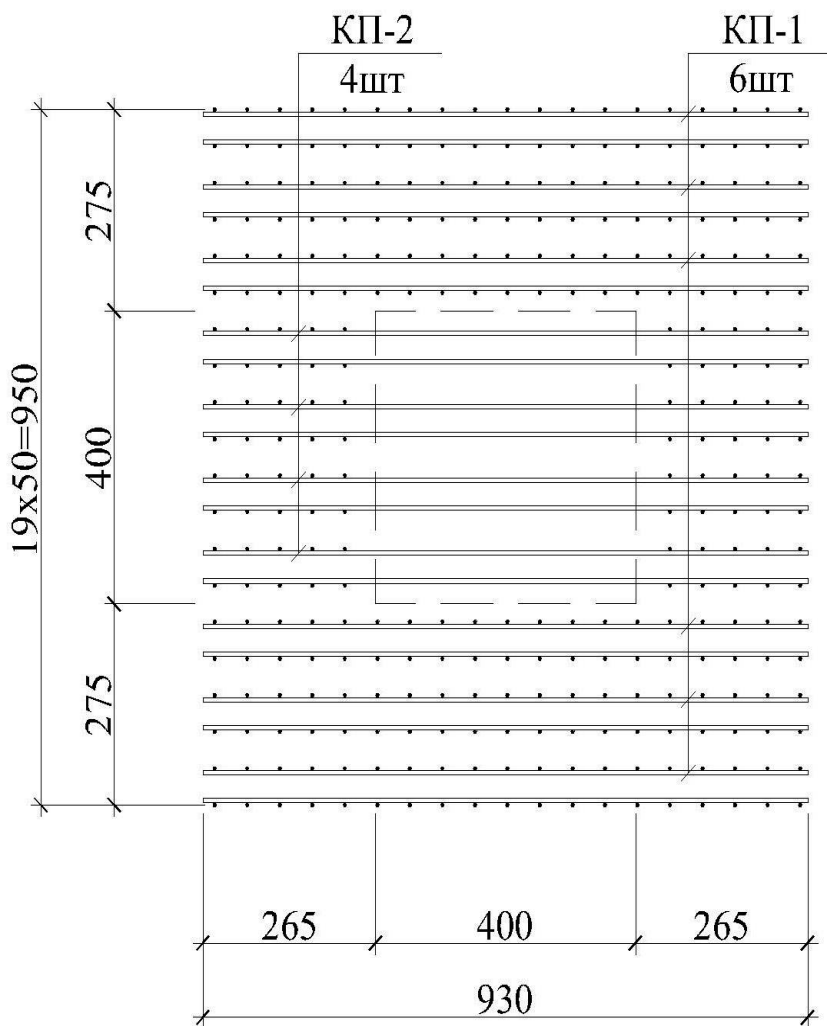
Фрагмент дополнительного армирования плиты перекрытия в зоне продавливания
